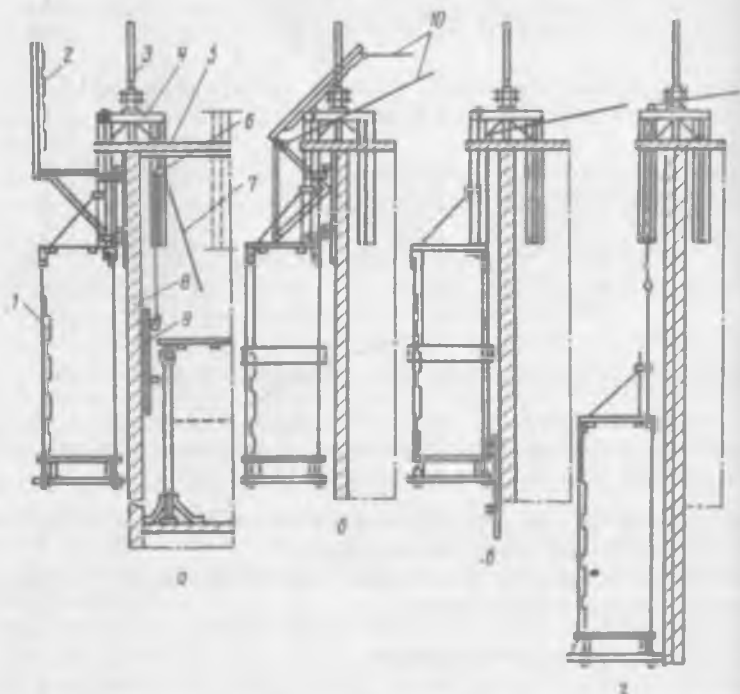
Поэлементный демонтаж скользящей опалубки:
